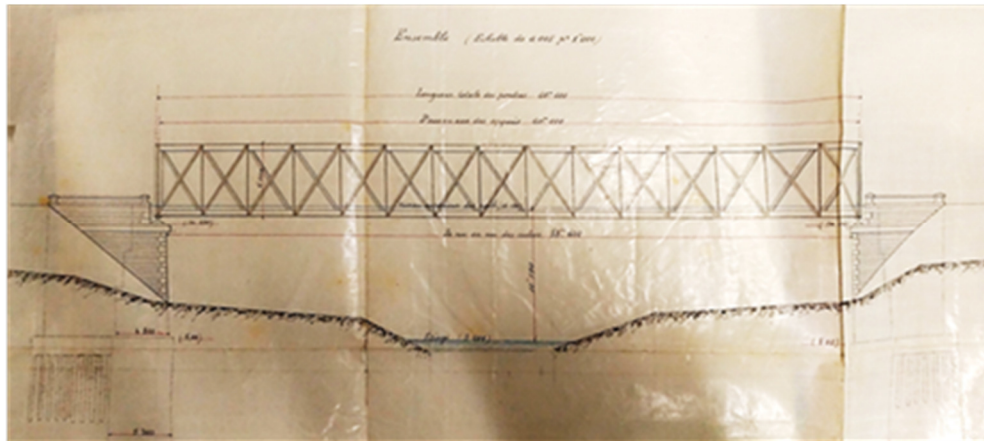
Planta do projeto original da Ponte do Alviela [41]
